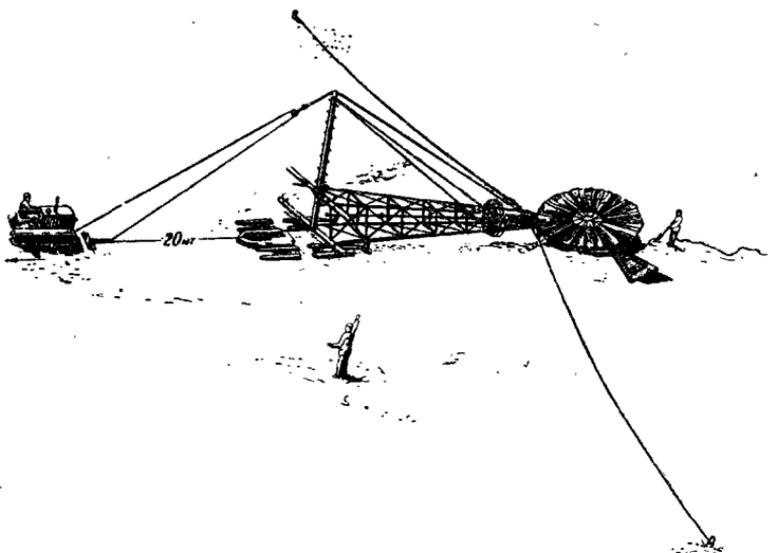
Ветродвигатель, подготовленный к подъему трактором.
